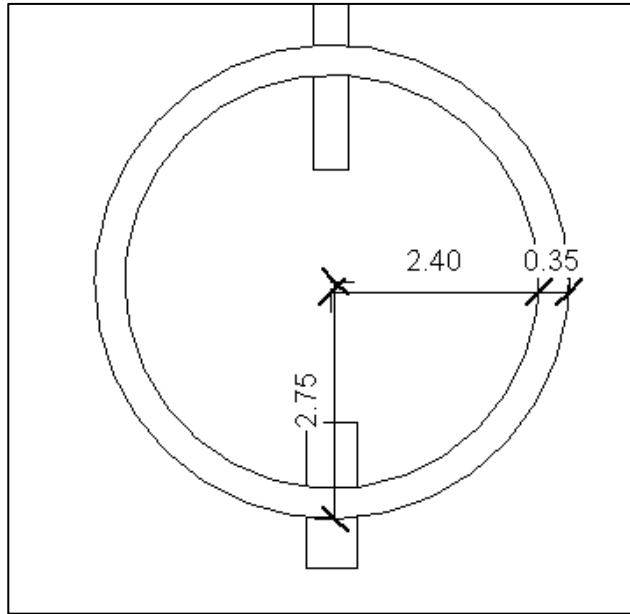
Vista en planta del digester de lodos [Baque & Zavala, 2021]
